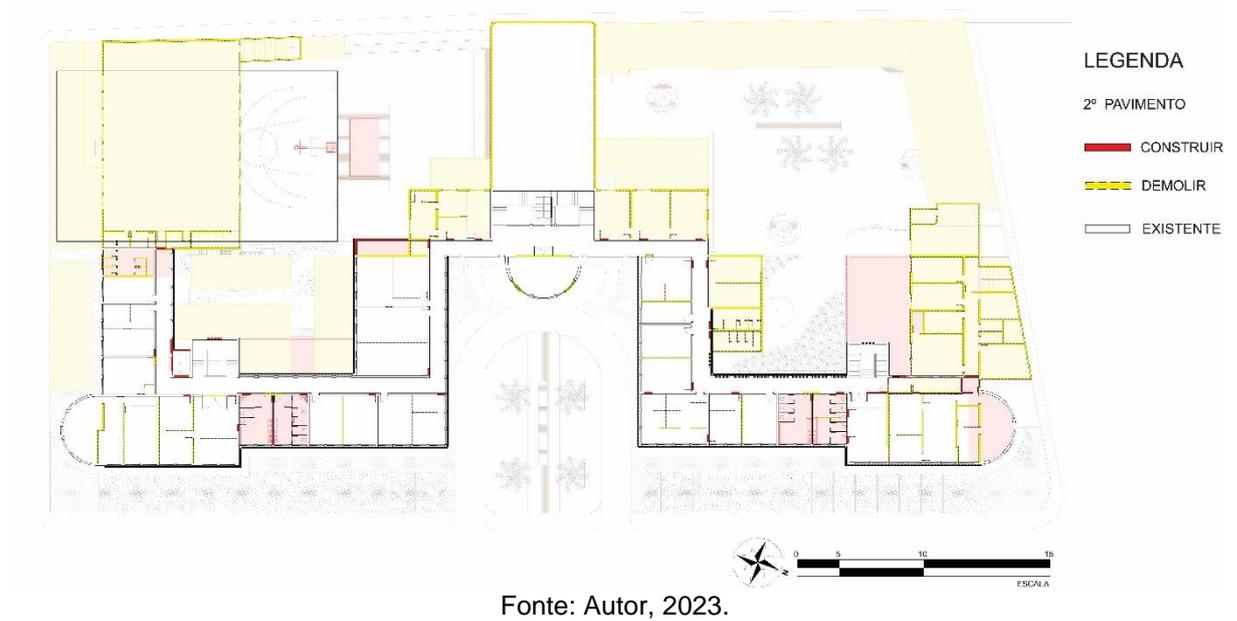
Planta baixa do 3º Pavimento: demolir/construir.
